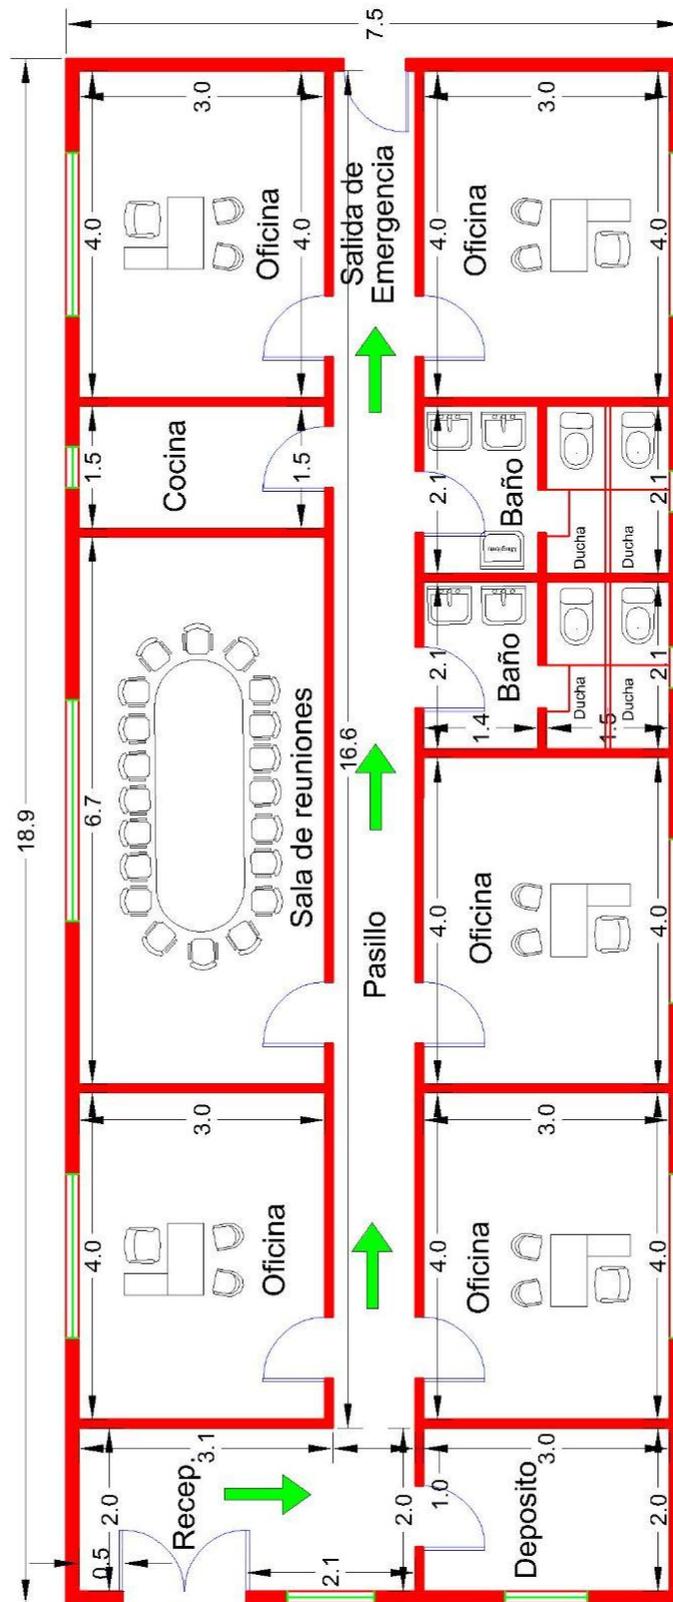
Plano de vista en planta del Edificio Administrativo
